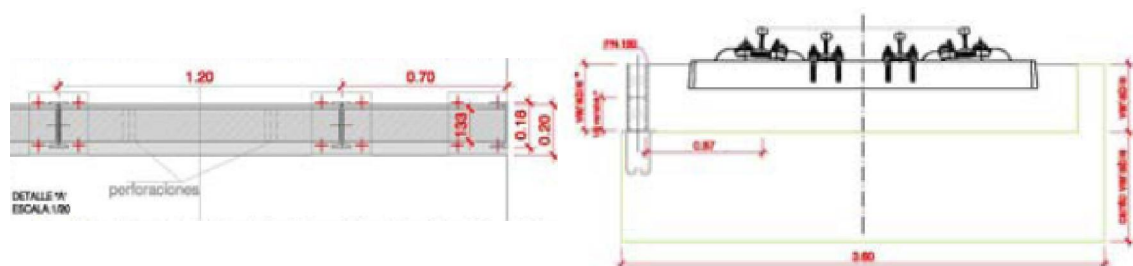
a) Planta del mur exterior. b) Alçat del tram de via confinat entre els murs. Extret de [9].
